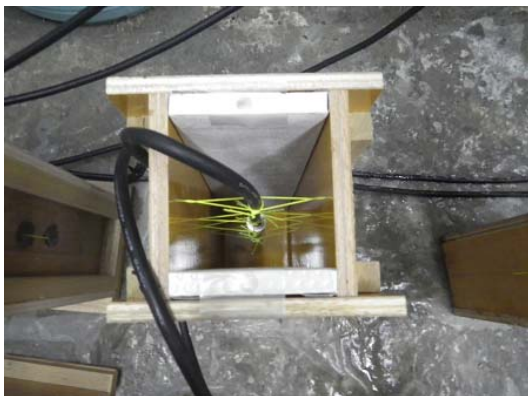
W キュアリング供試体の型枠と供試体の作製状況
